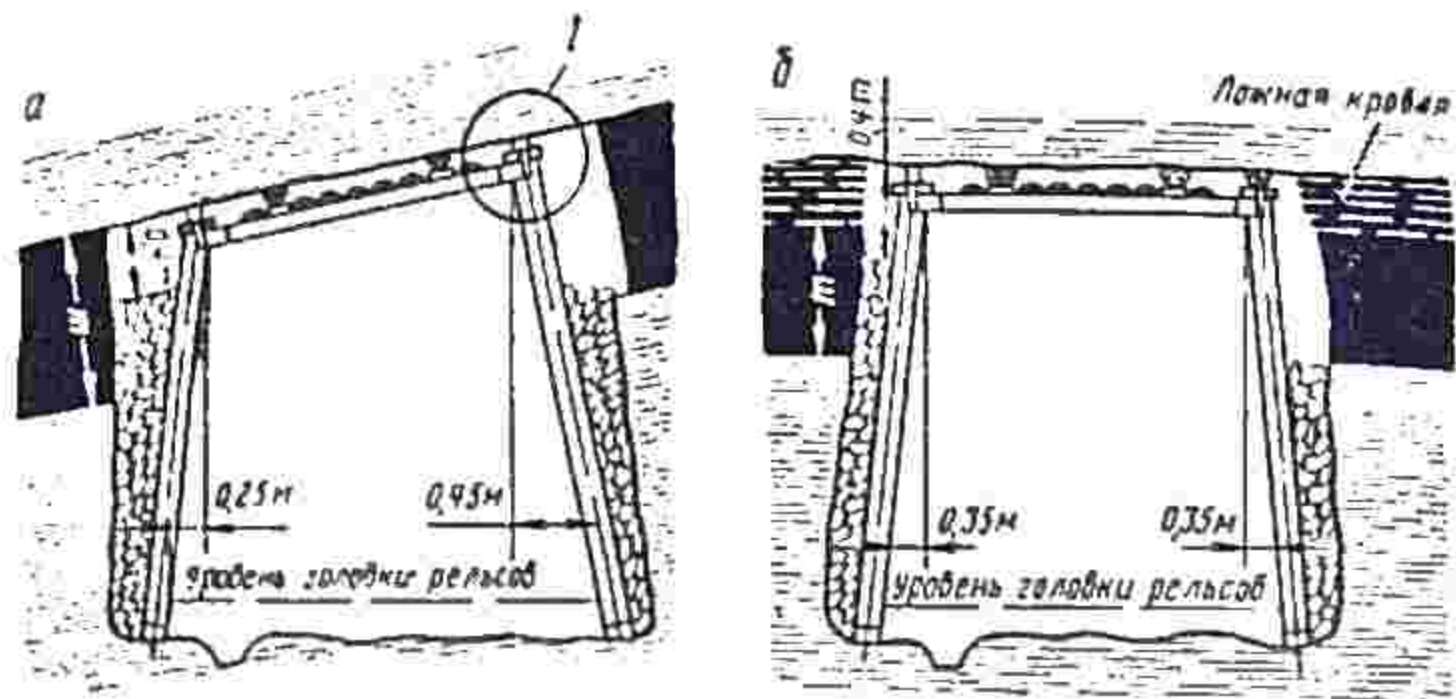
Установка железобетонной податливой крепи при разном угле падения пластов
